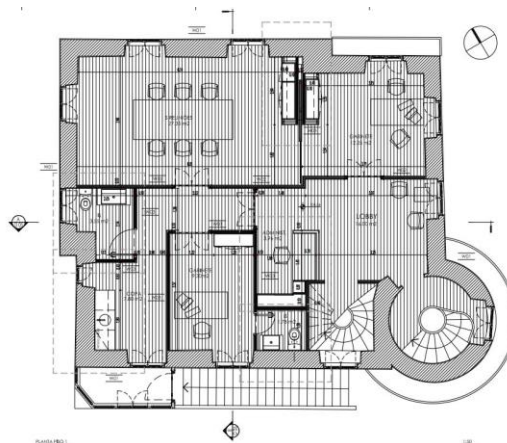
Planta Piso 1: Desenhos fornecidos pelo proprietário da Casa Cor de Rosa
